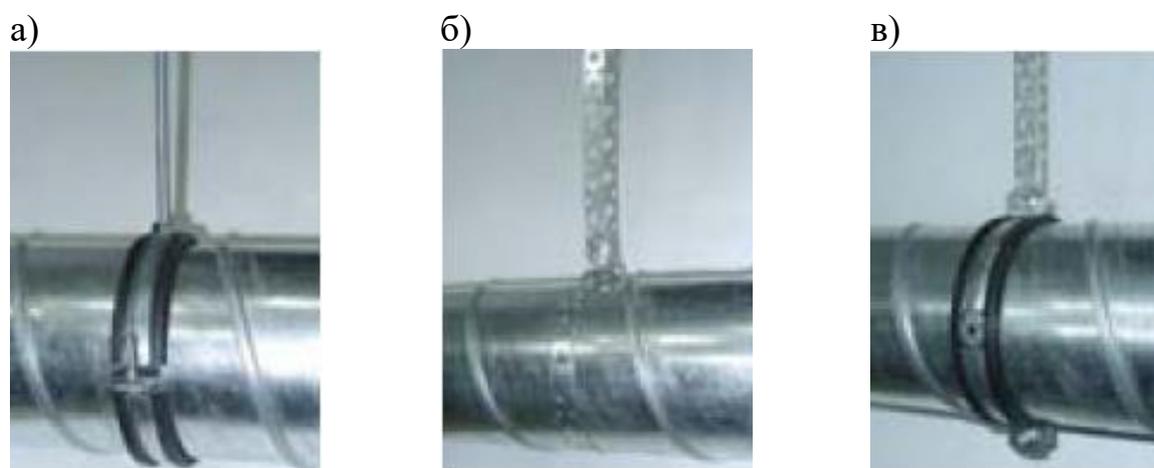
Крепление горизонтальных круглых воздухопроводов: а – при помощи хомута и шпильки; б – при помощи перфоленты без хомута; в – при помощи перфоленты и хомута
